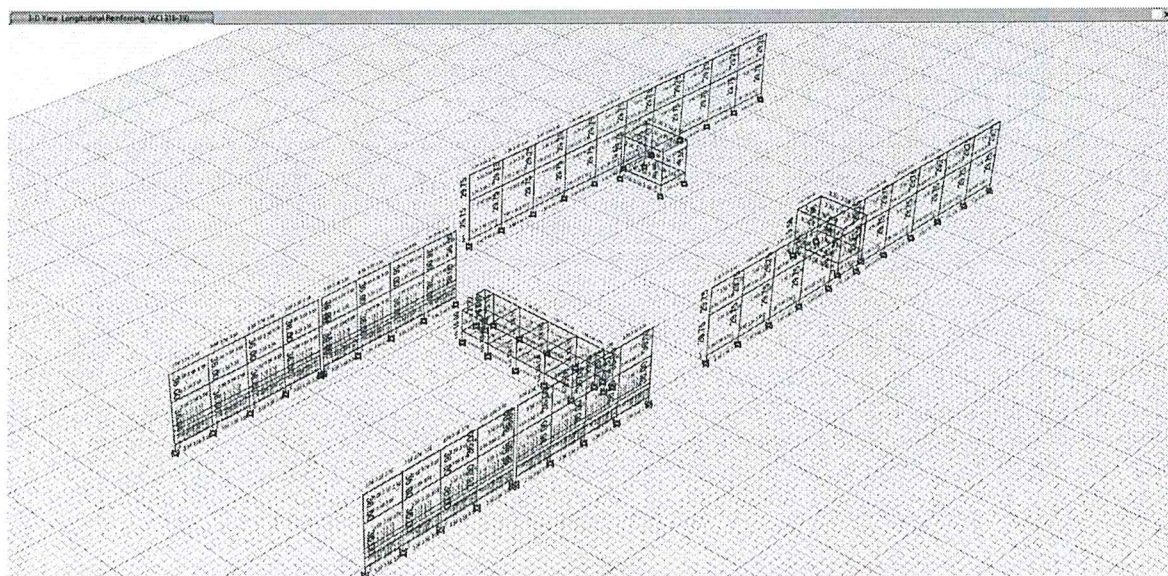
Vista en 3D – Edificación 19-20 - Diseño de Refuerzo Longitudinal y Transversal en las Vigas y Columnas, calculando el Área (As) en cm²; Calculado por el Programa ETABS Ultimate C 19.0.0.
